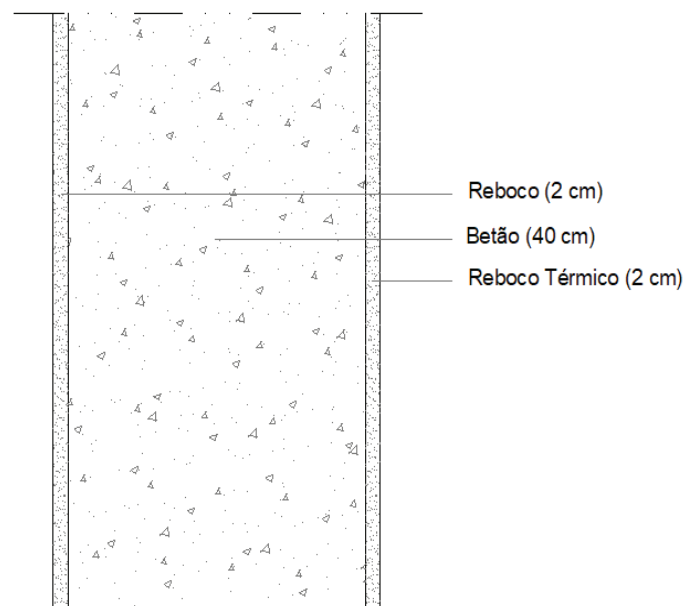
Pormenor construtivo da parede interior tipo I (escadas)
